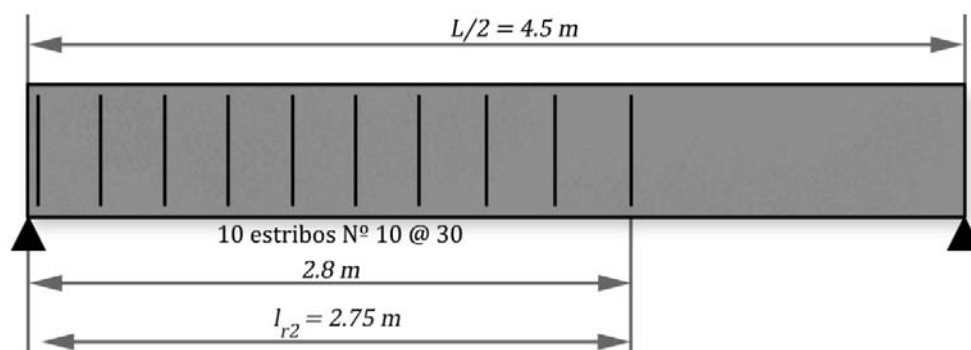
,39: Distribución del refuerzo transversal en los apoyos externos
